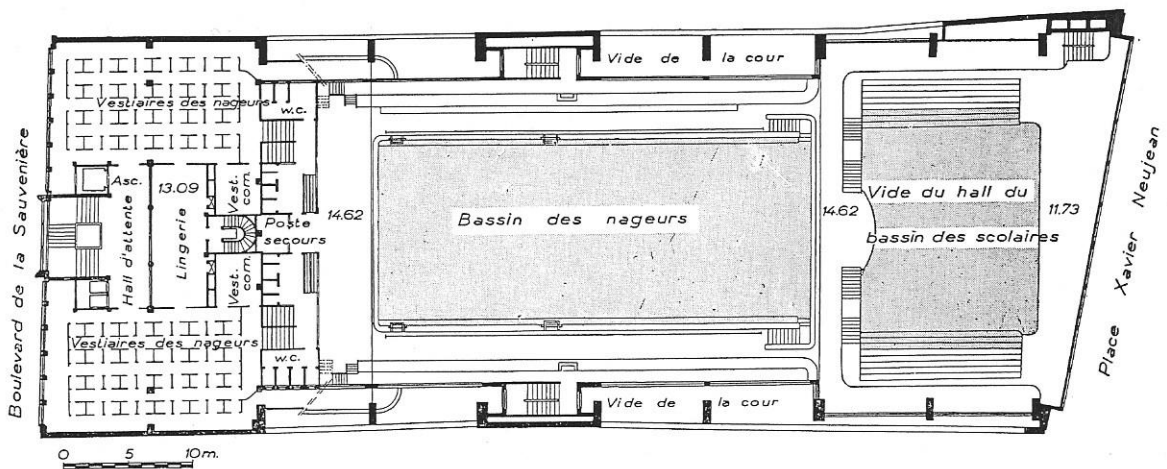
PLAN DU DEUXIÈME ÉTAGE. Niveau des bassins. Locaux d'hydrothérapie et de bains médicaux.
